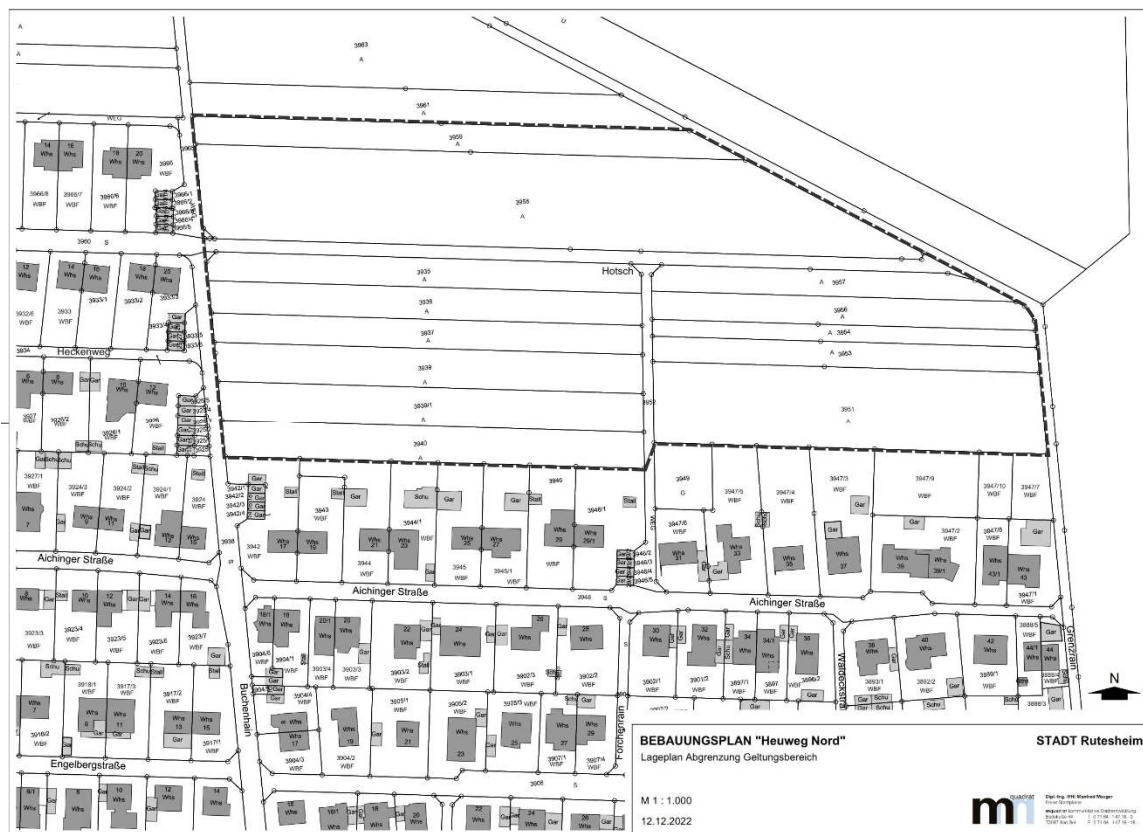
Lageplan zum Aufstellungsbeschluss vom 12.12.2022
